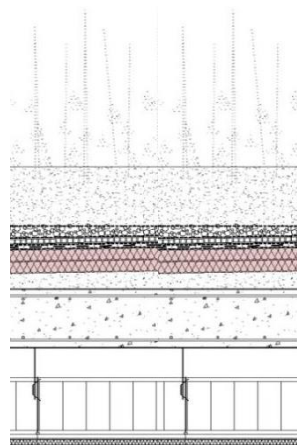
Sección tipo de cubierta extensiva, capas en el orden de la explicación referentemente.
